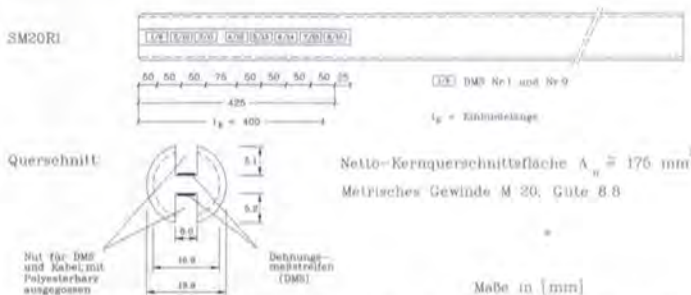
Längs- und Querschnitt für die Gewindestange des Körpers SM20R1
